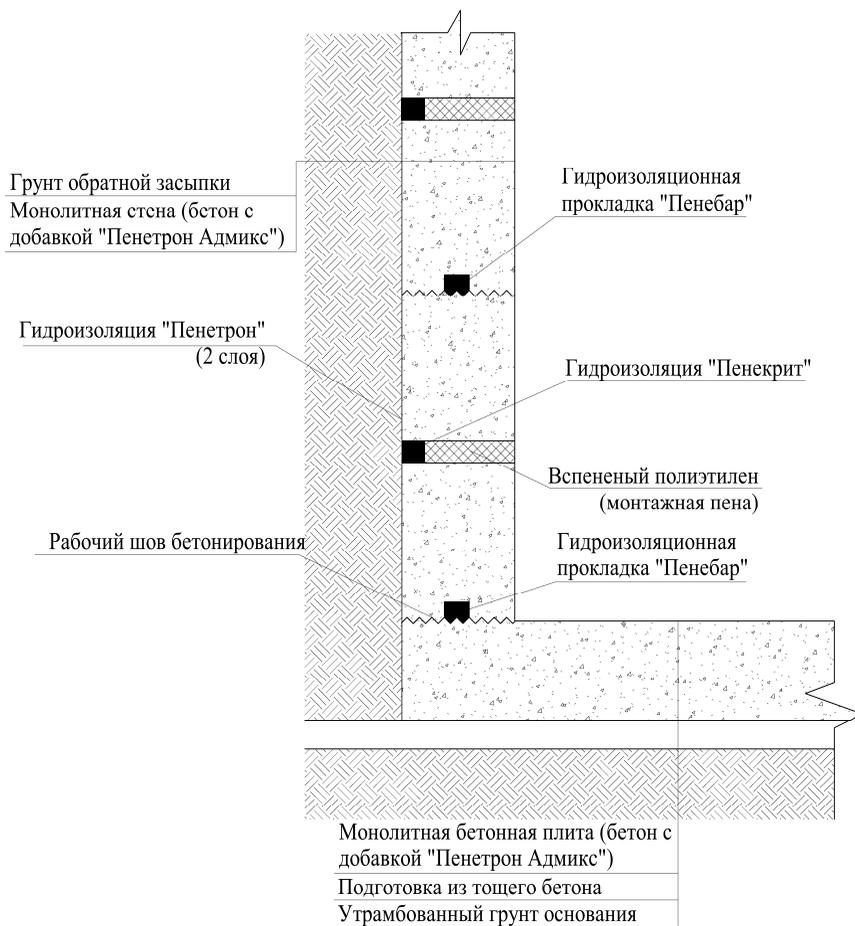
Б. Гидроизоляция технологических отверстий после удаления опалубки (строящая конструкция)
